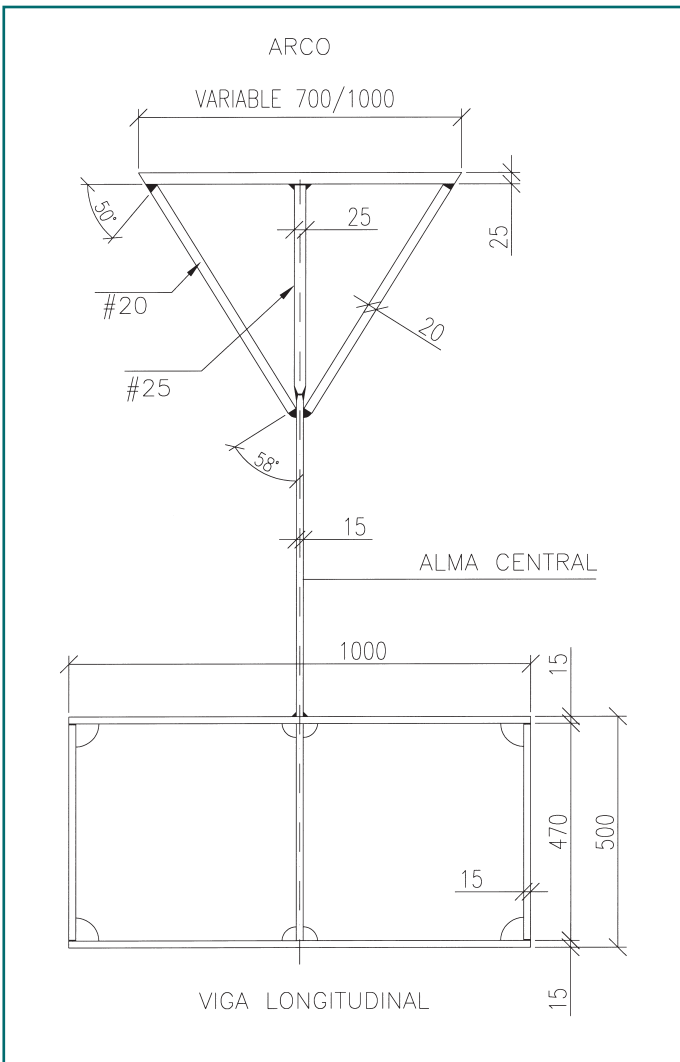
Sección transversal del arco y la viga longitudinal/Cross section of the arch and longitudinal beam.
